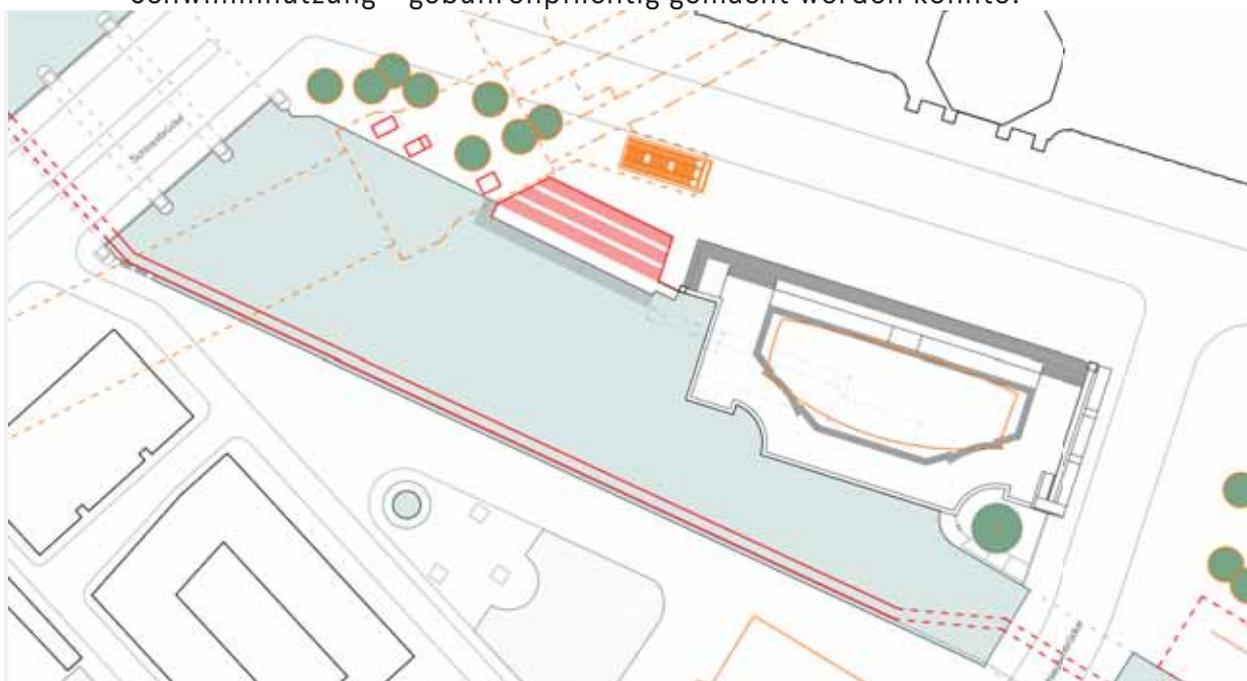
Schwimmbereich Grundriss Wasserzugang Schlossfreiheit (4_LP_VarianteZW-Gesamt-Massn_1000.pdf)
